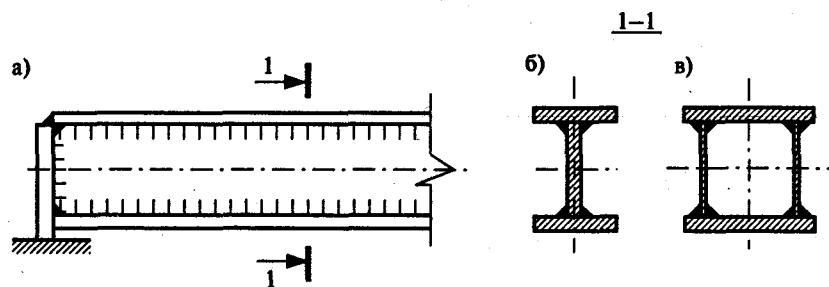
Сварные балки: а) вид сбоку; б) балка двутаврового сечения; в) балка двустенчатого сечения
